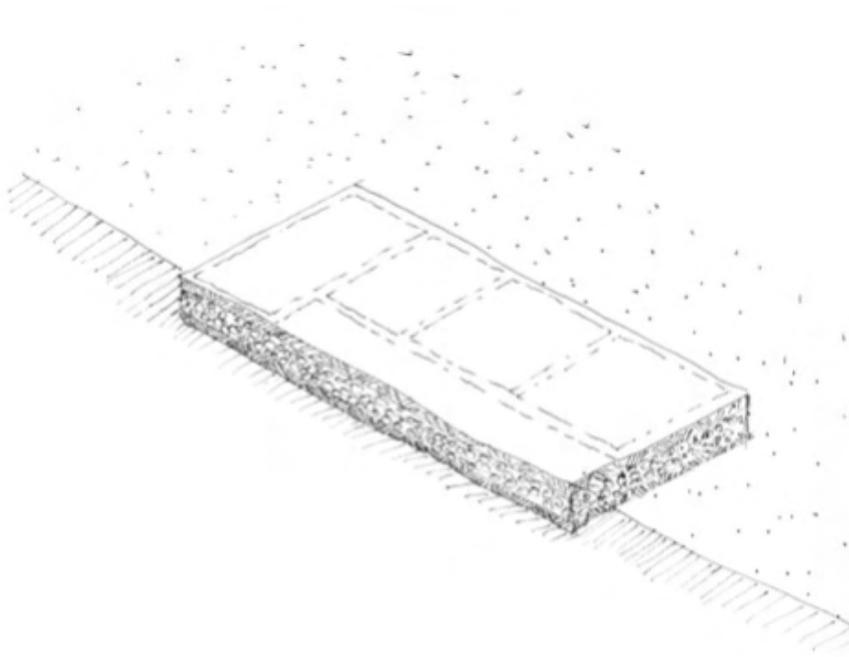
Haus ohne Fundament, verdichteter Boden, Schotterschicht, fette Lehmschicht unter einem typischen Grundriss
